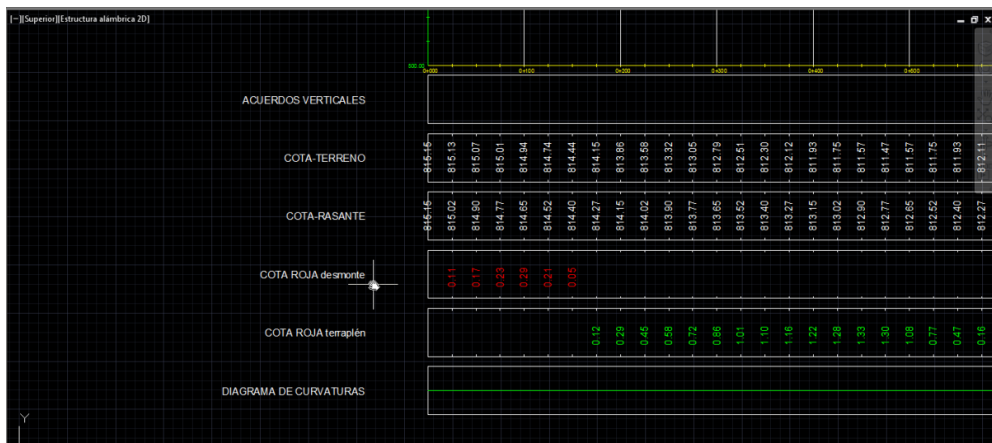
Detalle de los parámetros del perfil longitudinal calculados para el eje primario del ejemplo con avances largos.
